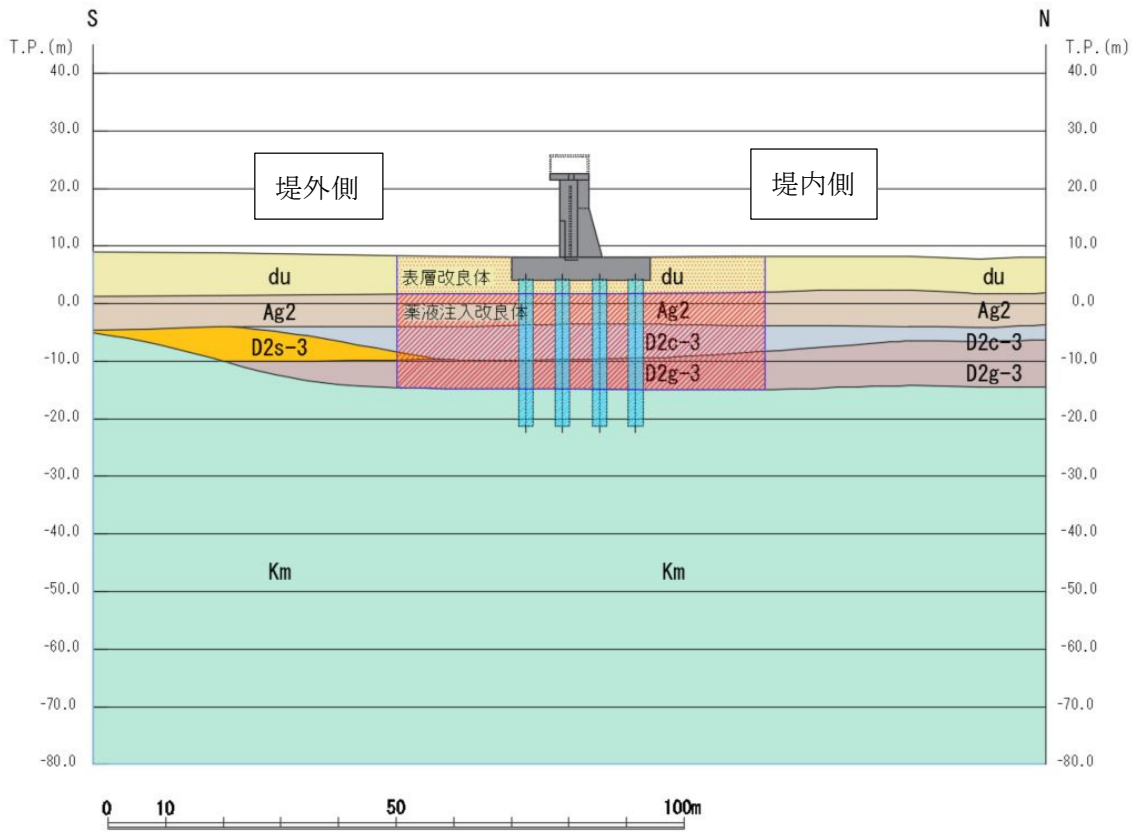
防潮扉 2 基礎 評価対象断面図 (A-A)
